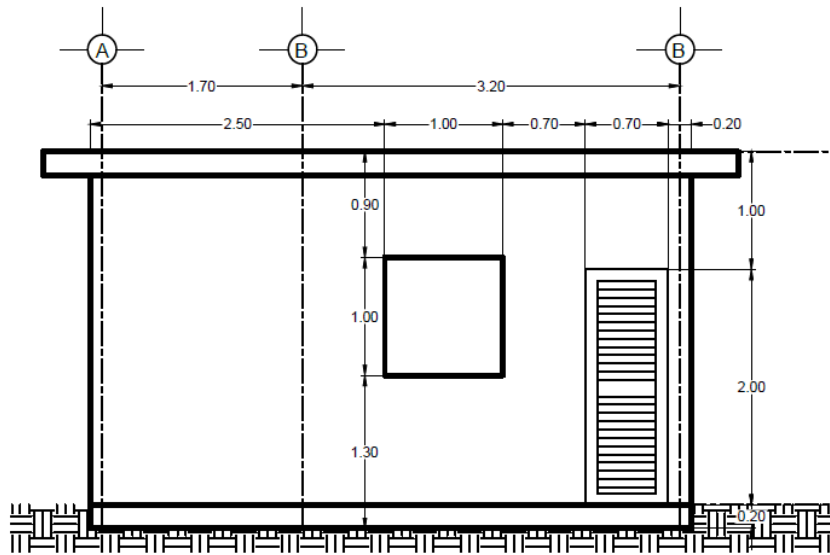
Vista Alzado Frontal (Caseta de Vigilancia)
